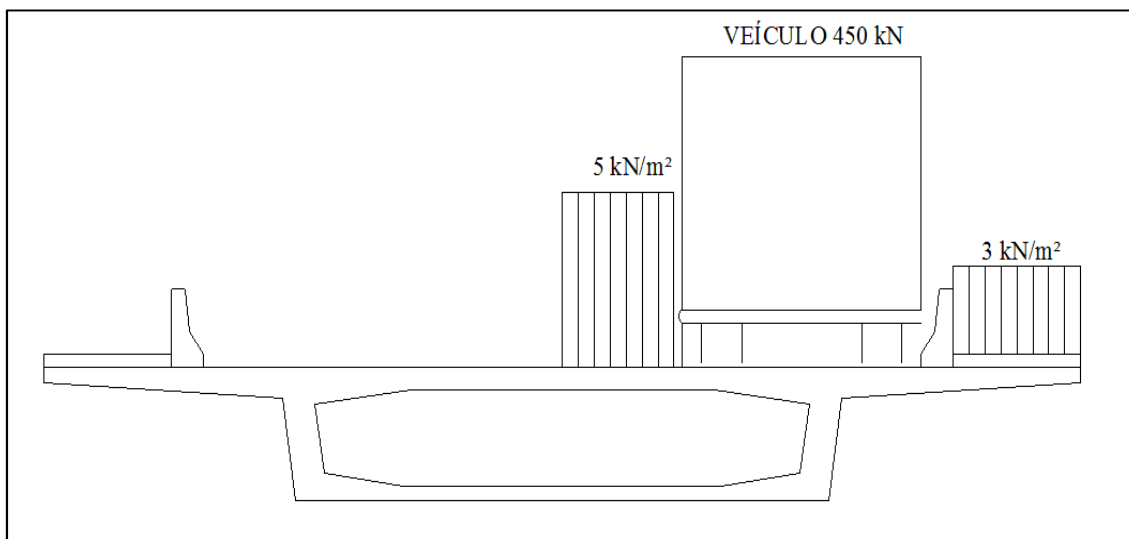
Disposição transversal das cargas para tabuleiro parcialmente carregado
